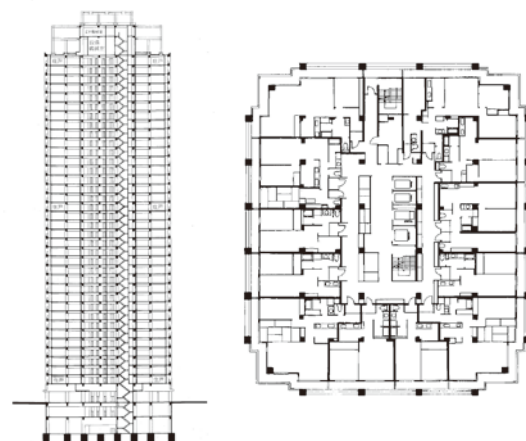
類型Ⅰ イーストタワーズ 平面図・断面図⁸⁾
